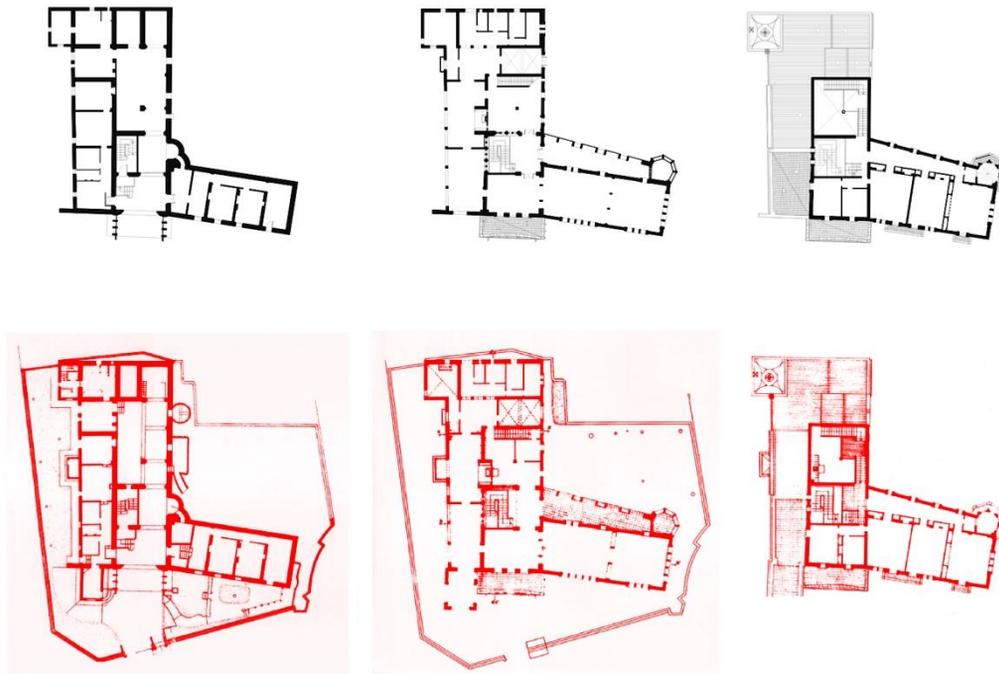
Casa Roviralta, 1903, del arquitecto Joan Rubió i Bellvé. Planta baja, tipo y ático. Transformada en el Restaurante El Asador de Aranda, por el arquitecto Antoni de Moragas (Avenida Tibidabo, 31).
